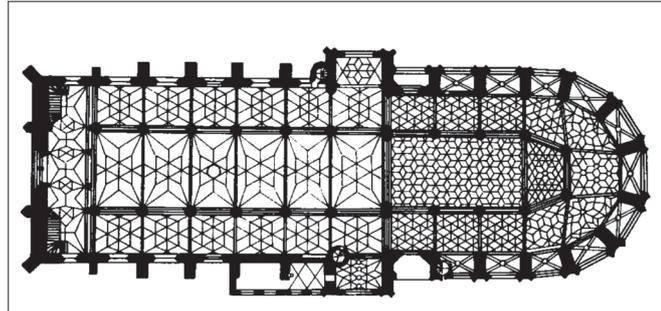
Grundriss mit Hallenumgangschor der Hl. Kreuz-Kirche in Schwäbisch Gmünd
